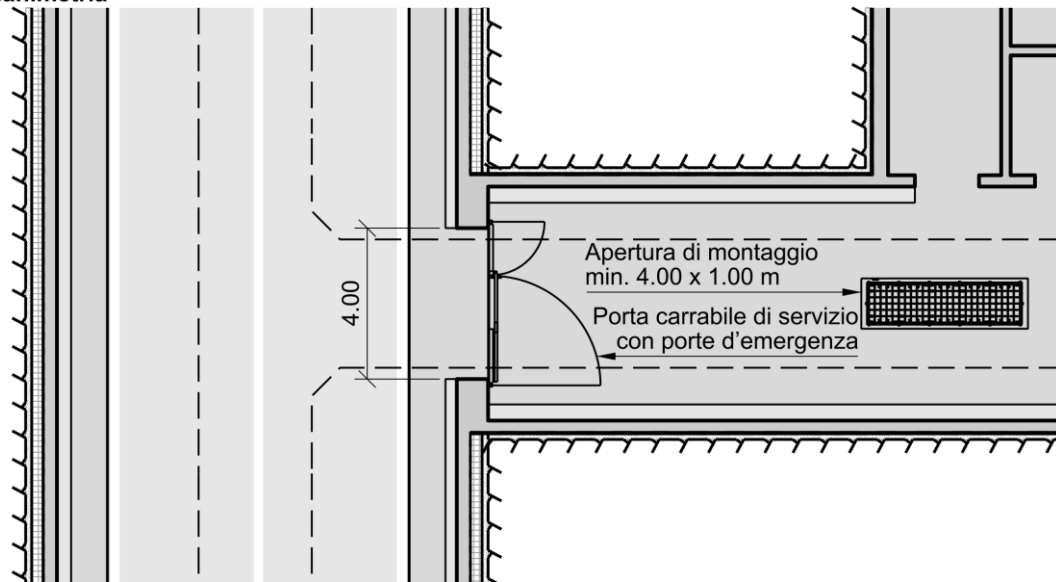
Planimetria con apertura di montaggio verso il canale tecnico
